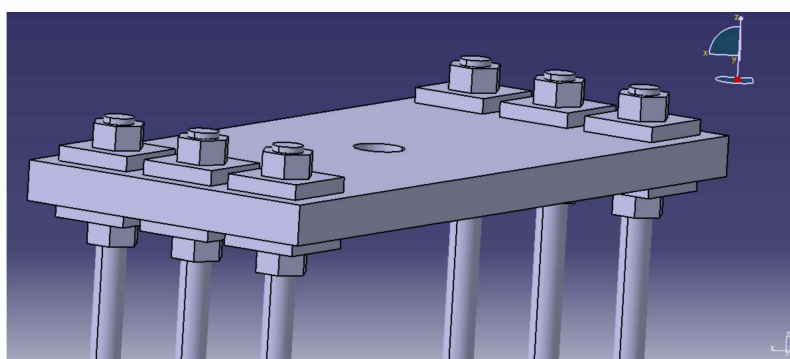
Representación 3D del anclaje del cierre frontal en Catia
